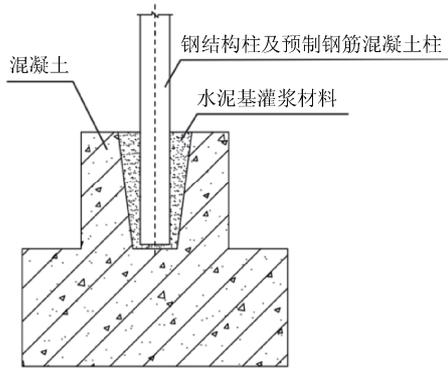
预制钢筋混凝土柱或插入式钢结构柱柱脚灌浆
